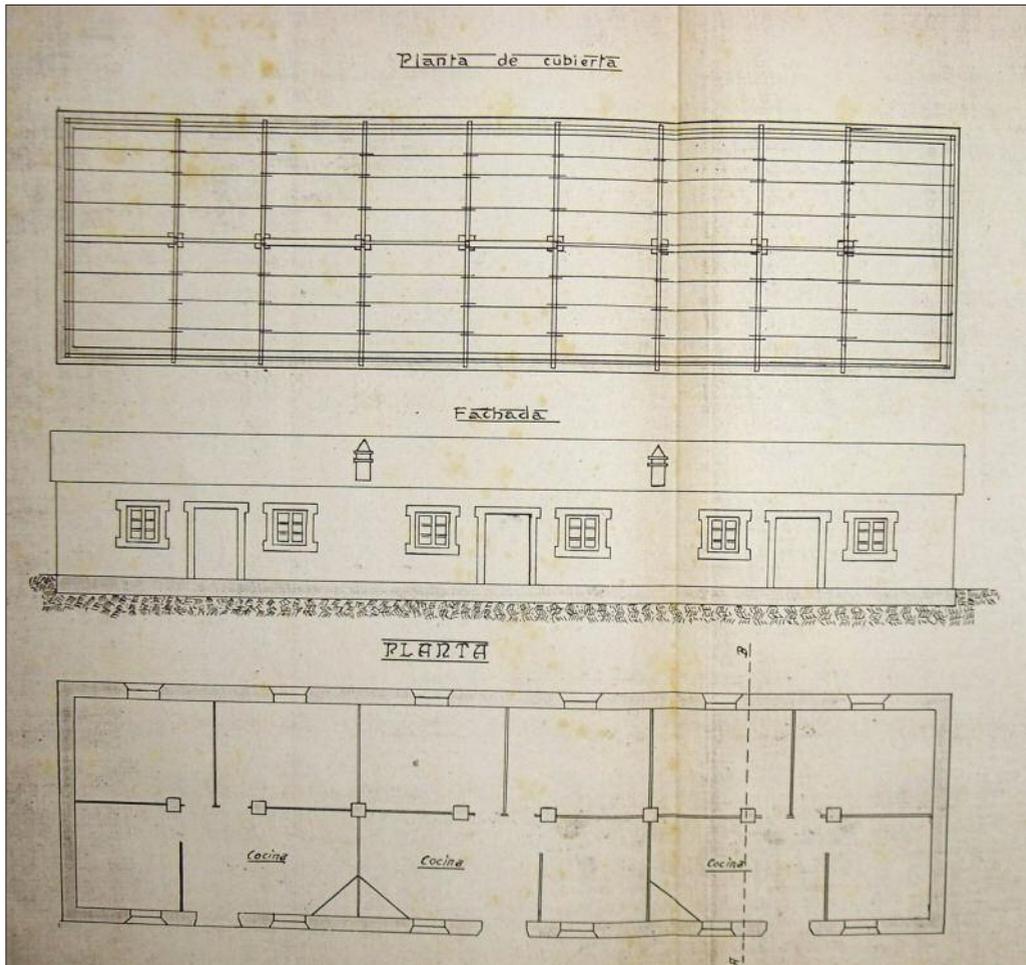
Plano del proyecto de casas para tres viviendas de Tahivilla. 1935.
